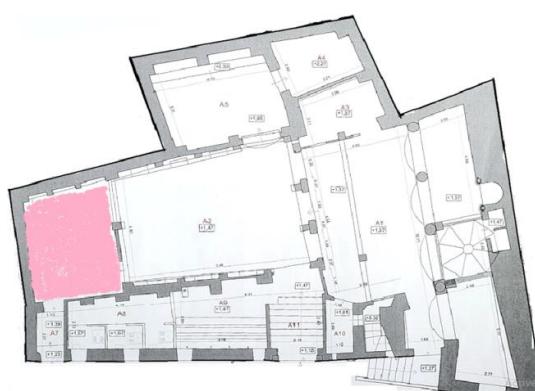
La salle de prière des femmes. Source : Fond de plan Rocca, traitement auteure
